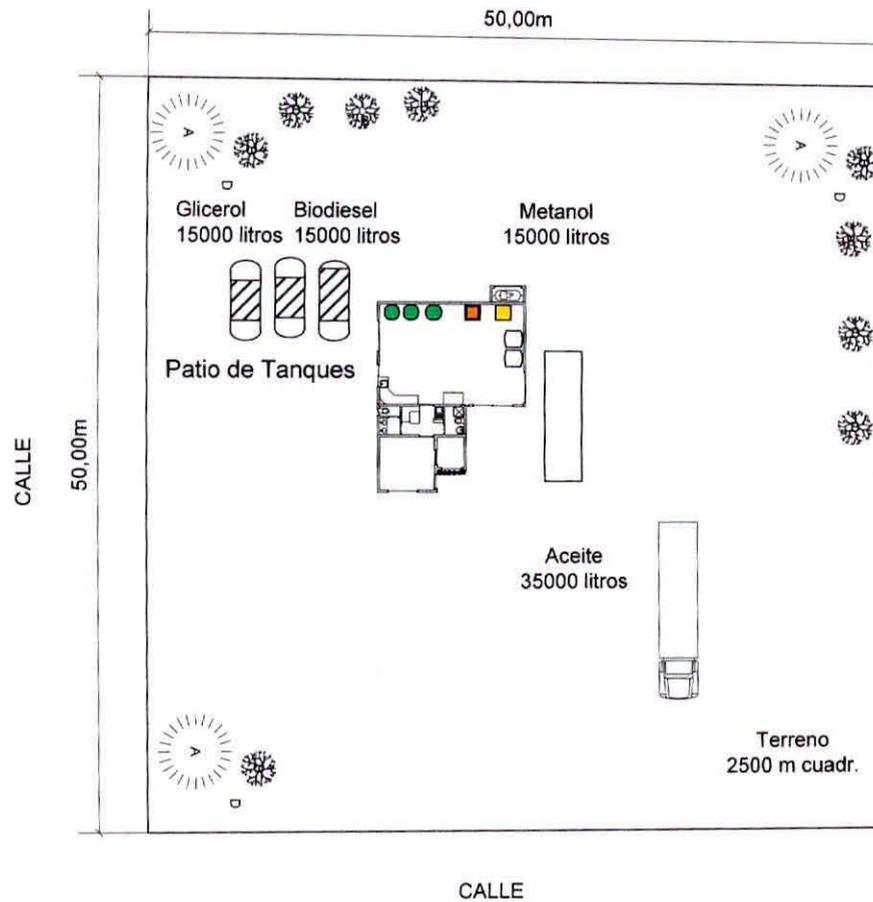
Plano de ubicación propuesta de la planta y sus instalaciones dentro del terreno.
